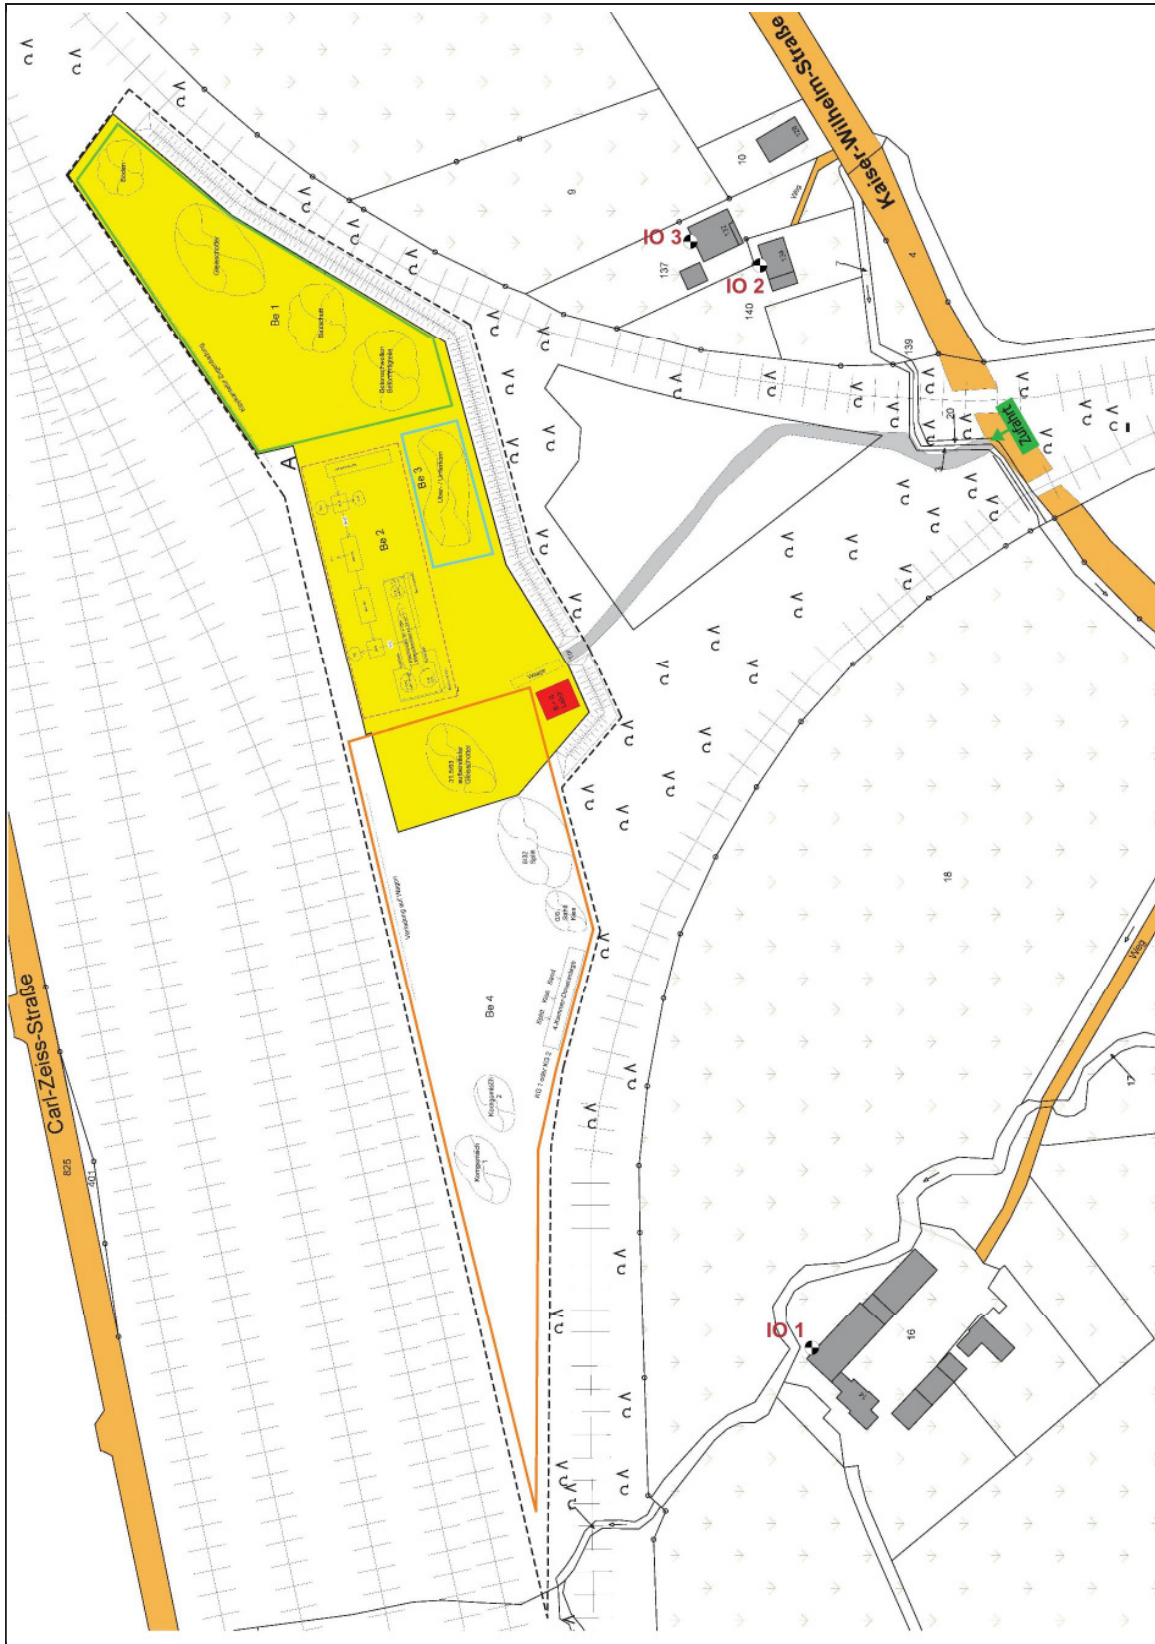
Lageplan mit Betriebseinheiten (aus [6]) sowie Immissionsorten (IO)
